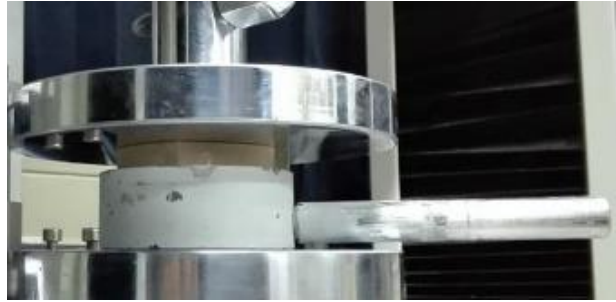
Ejecución del RCT en la máquina universal de ensayo
